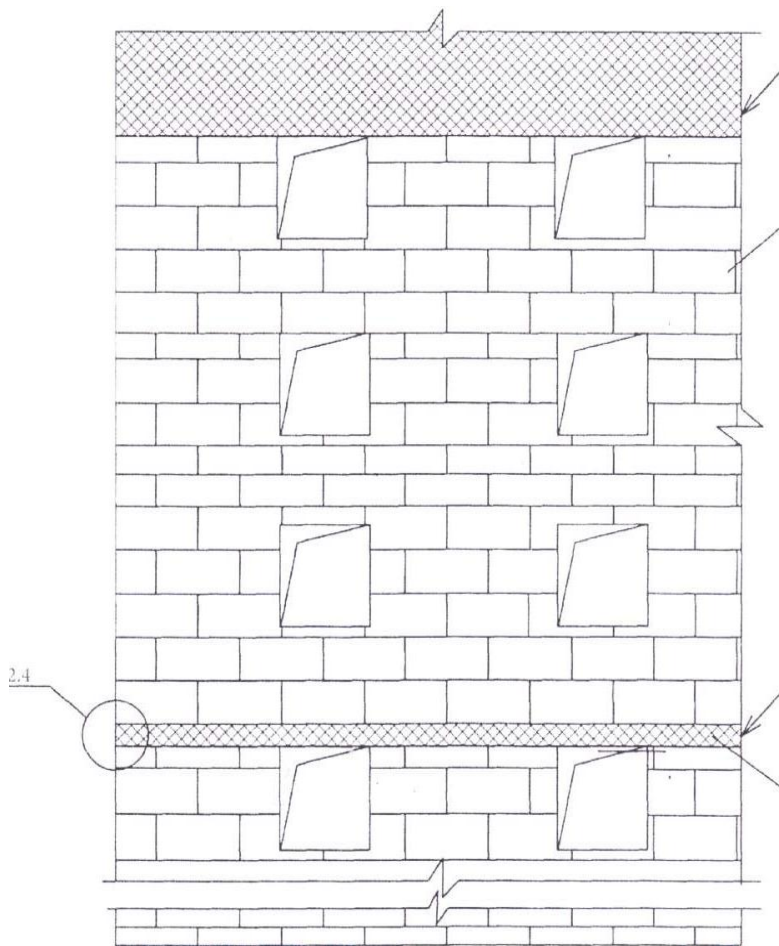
Схема розміщення плит утеплювача, сітки та штукатурки на фасаді будівлі
